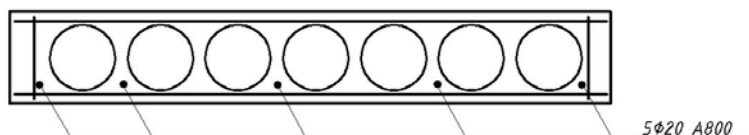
Схема армирования продольной рабочей арматуры.
